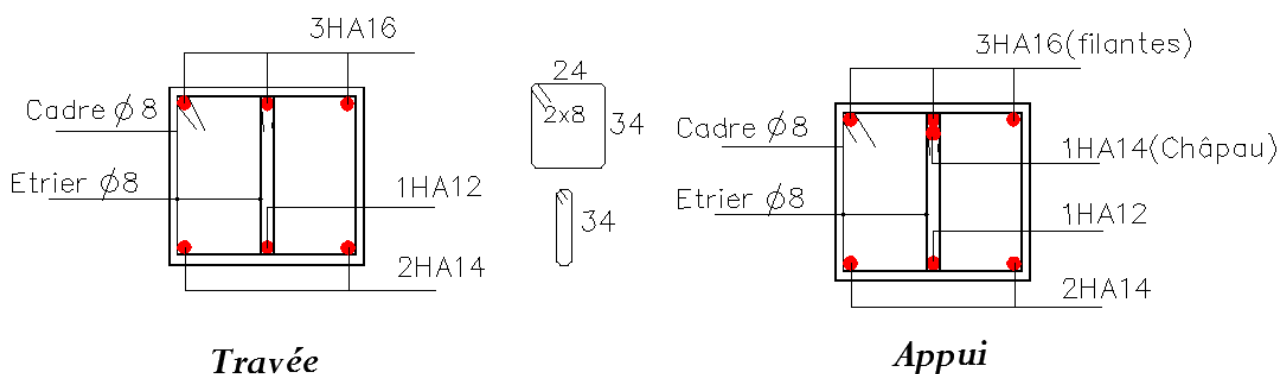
Schéma de ferrailage de la poutre principale du plancher RDC
